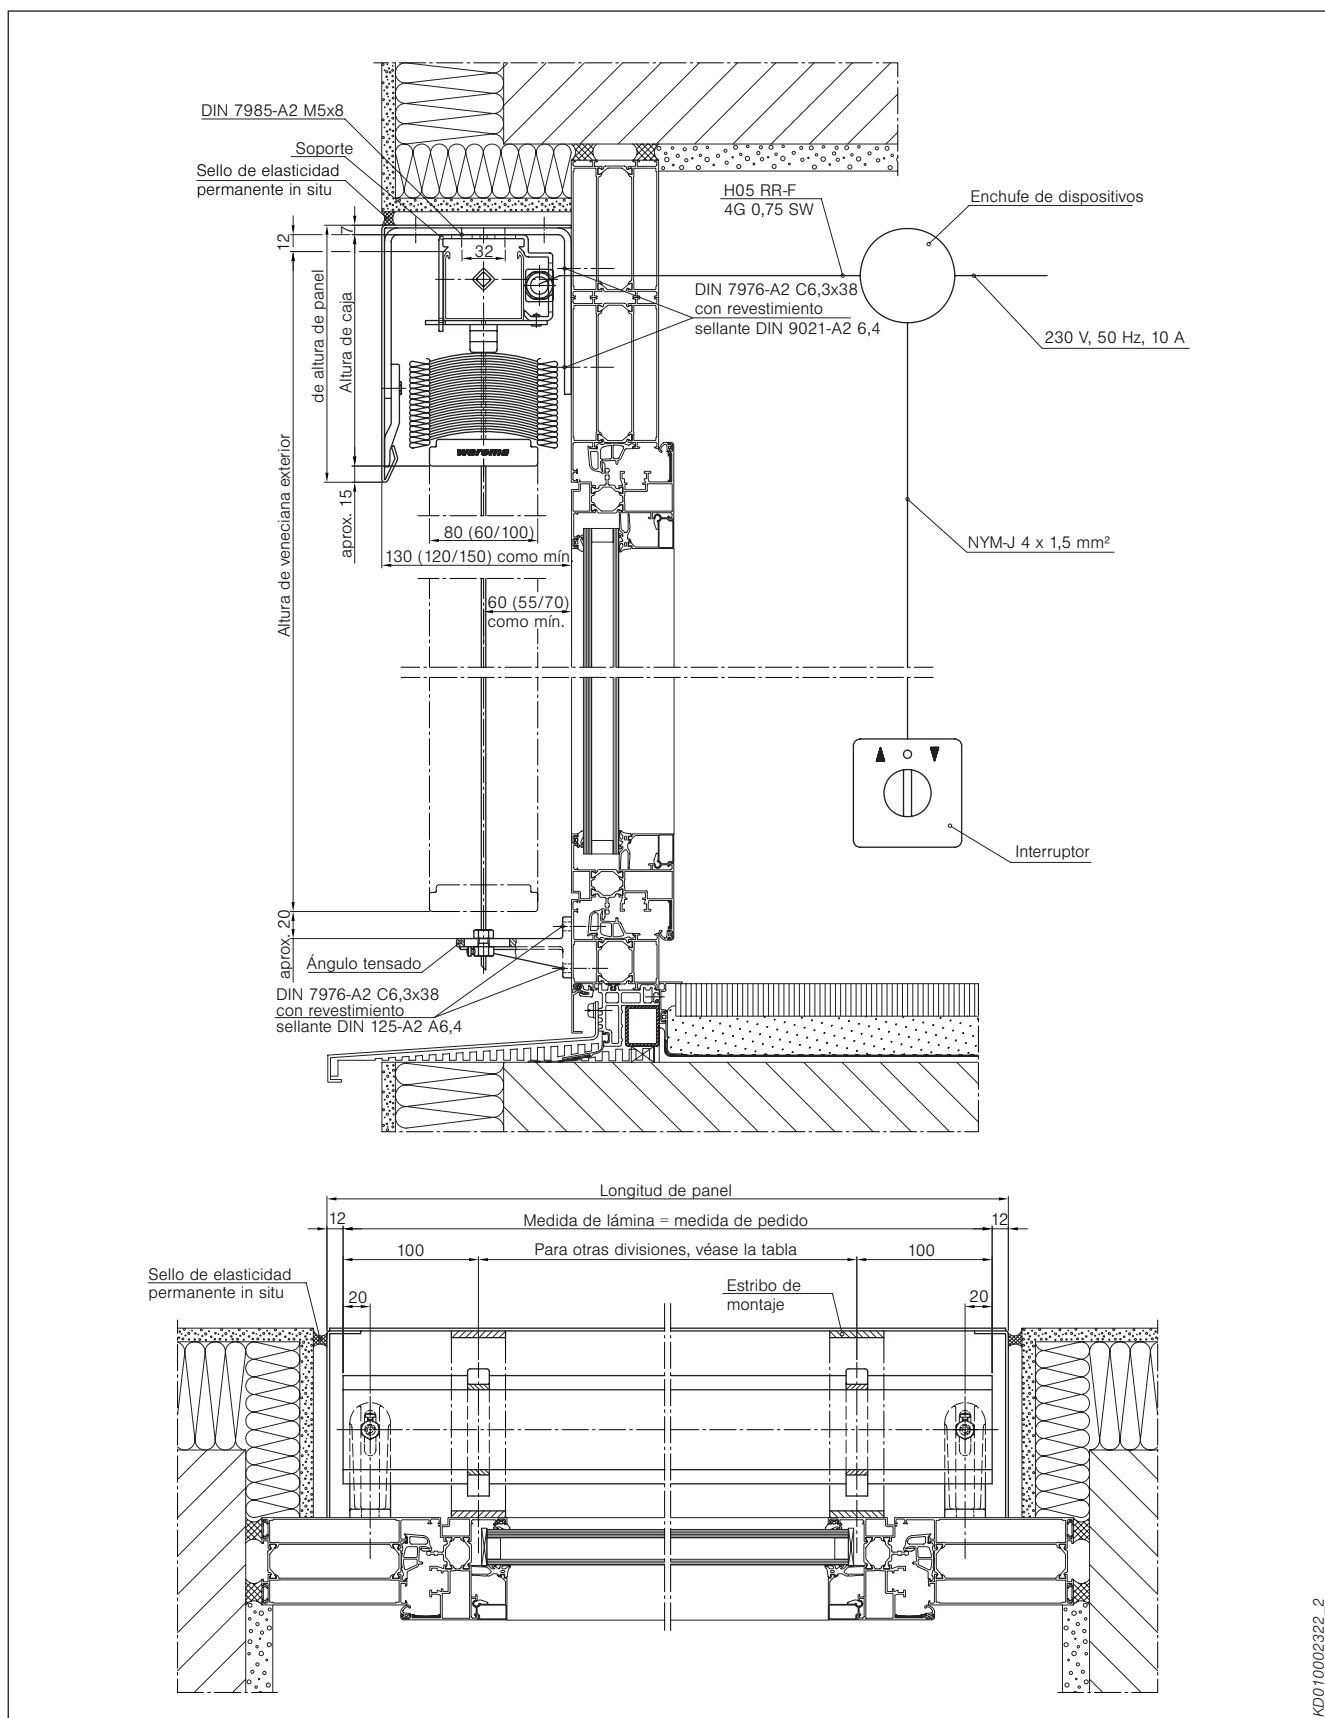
Ejemplo de montaje persianas venecianas exteriores tipos E 60/80/100 AF con láminas planas en un panel de protección en ángulo
